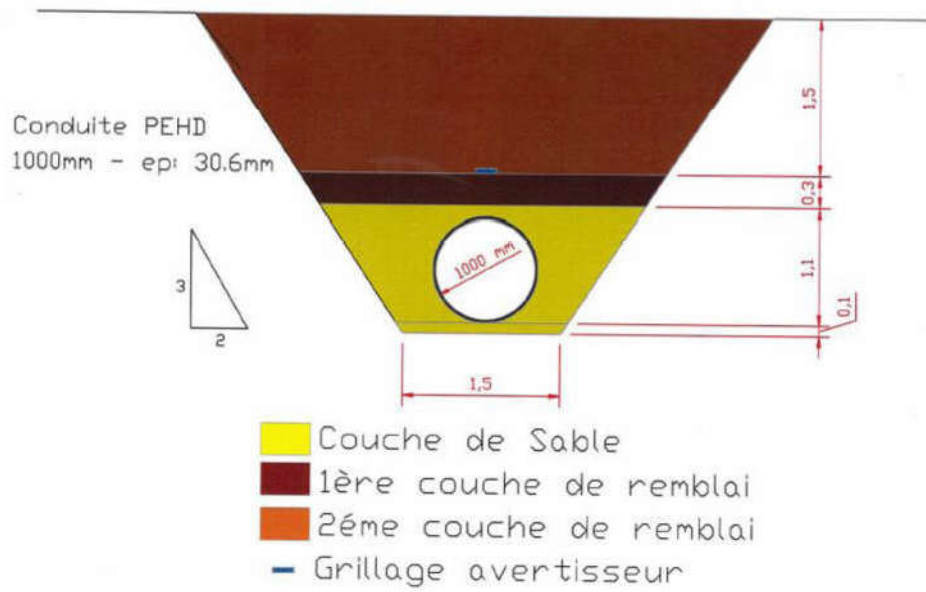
SECTION TYPE DE LA FUTURE CONDUITE FORCÉE
